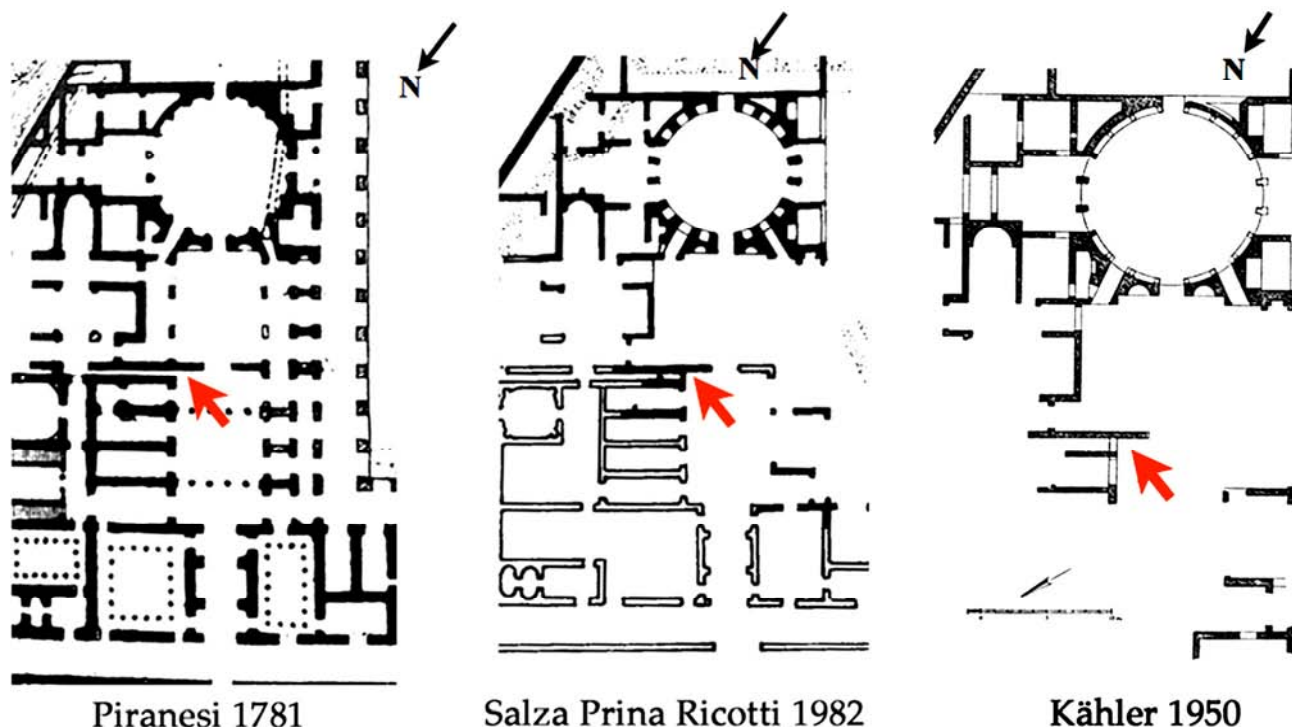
Tre planimetrie a confronto: la pianta di Piranesi mostra un doppio muro che in realtà non esiste, indicato dalla freccia rossa. La pianta della Salza Prina Ricotti del 1982 ripete l'errore, mentre la pianta di Kähler del 1950, frutto di un rilievo più accurato, riporta la situazione reale con un solo muro, come confermato dal nostro rilievo (elaborato da PIRANESI 1781, tav. III, SALZA PRINA RICOTTI 1982, tav. V e KÄHLER 1950, tav. XI).
